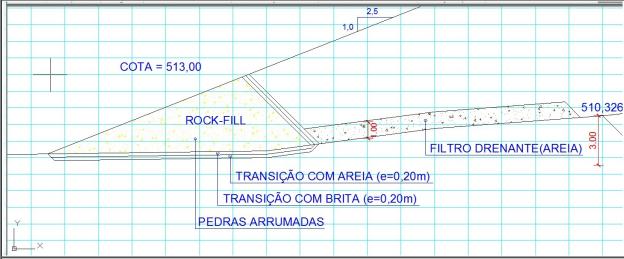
Perfil da barragem. Detalhe do Rock Fill (Projeto apresentado pela Prefeitura de Picuí).
